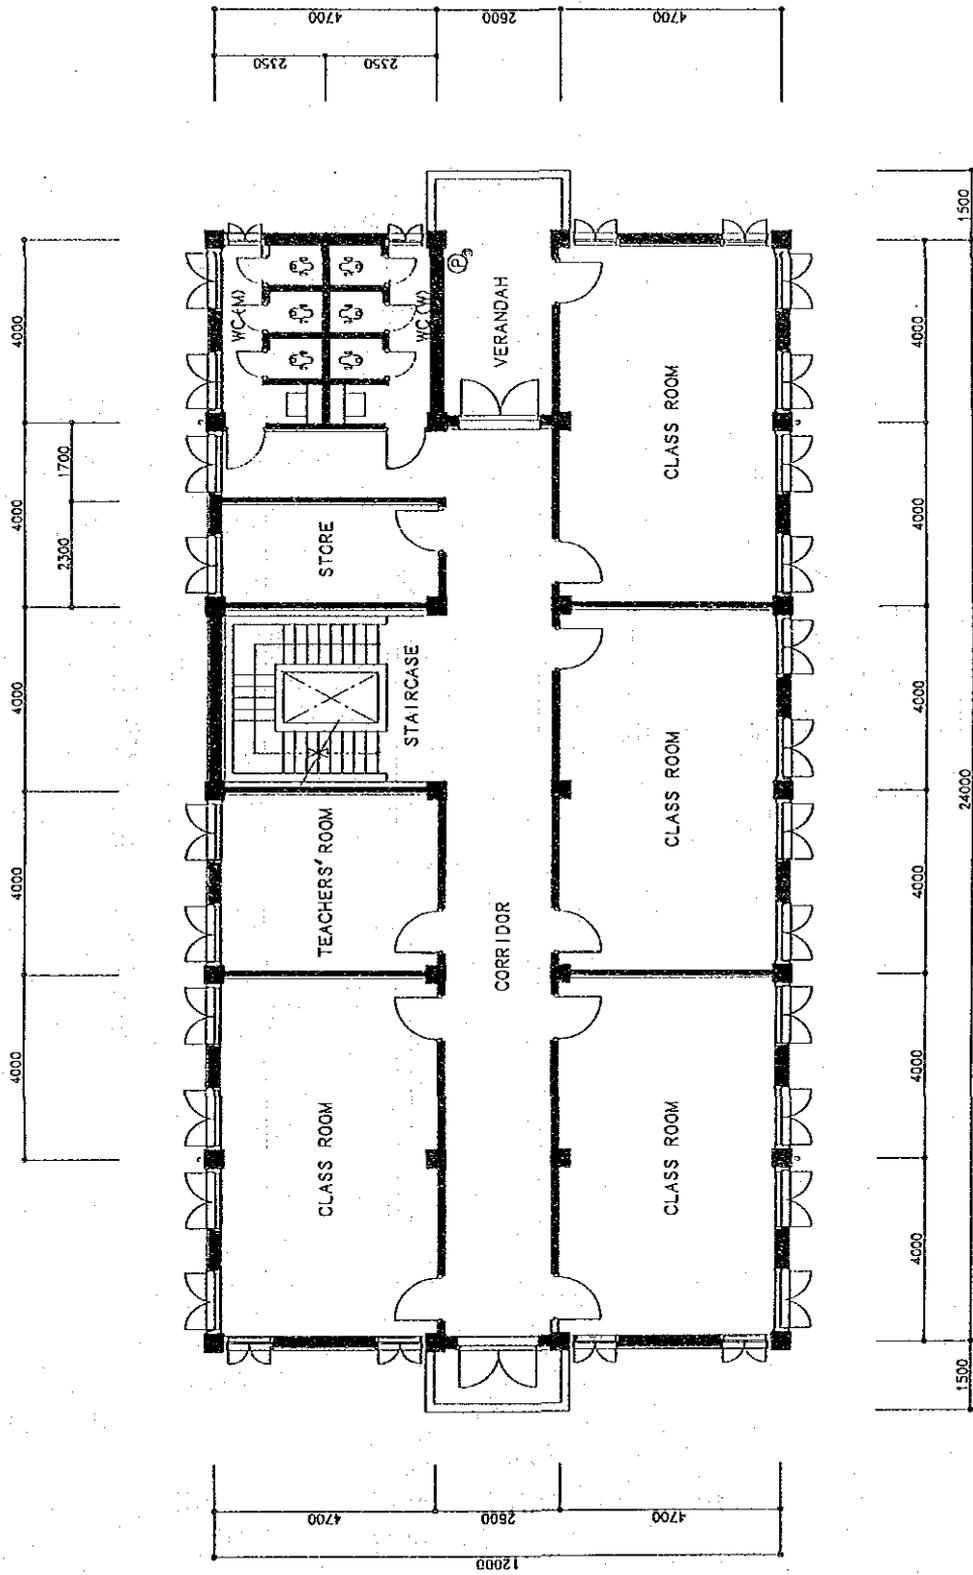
(2) 2階平面図 (4教室タイプ)
